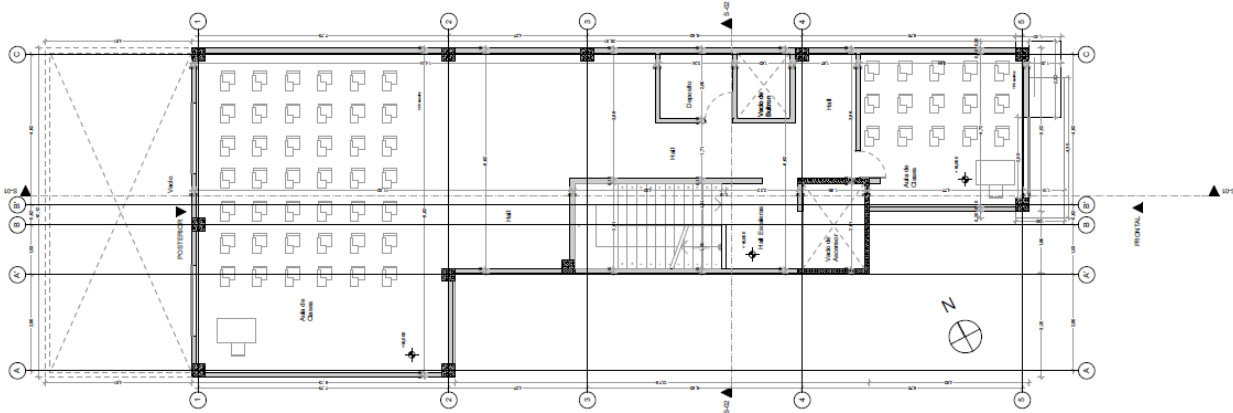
Planta Arquitectónica 5 Primer Piso Actual Cafaba.
